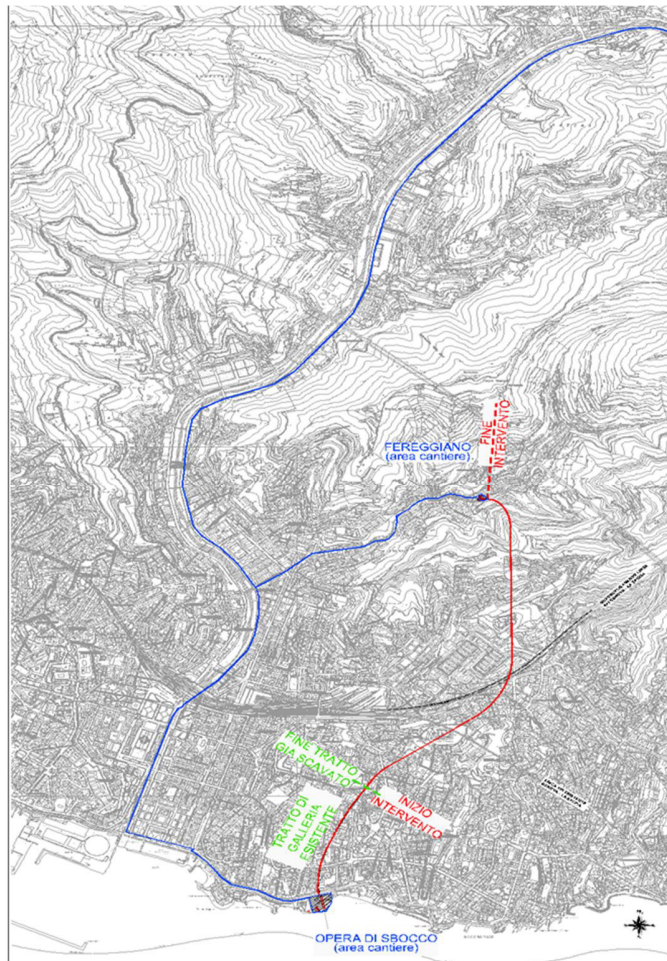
Planimetria di cantiere con individuazione aree cantiere
